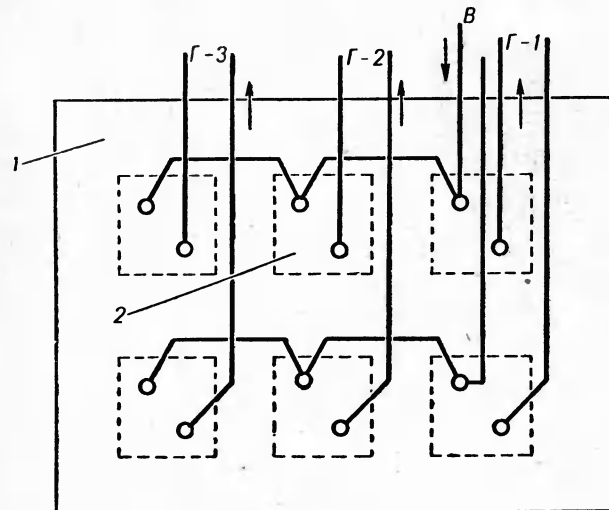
Монтаж проводов на задней стенке группового предохранительного щитка, изображенного на рис. 8:
